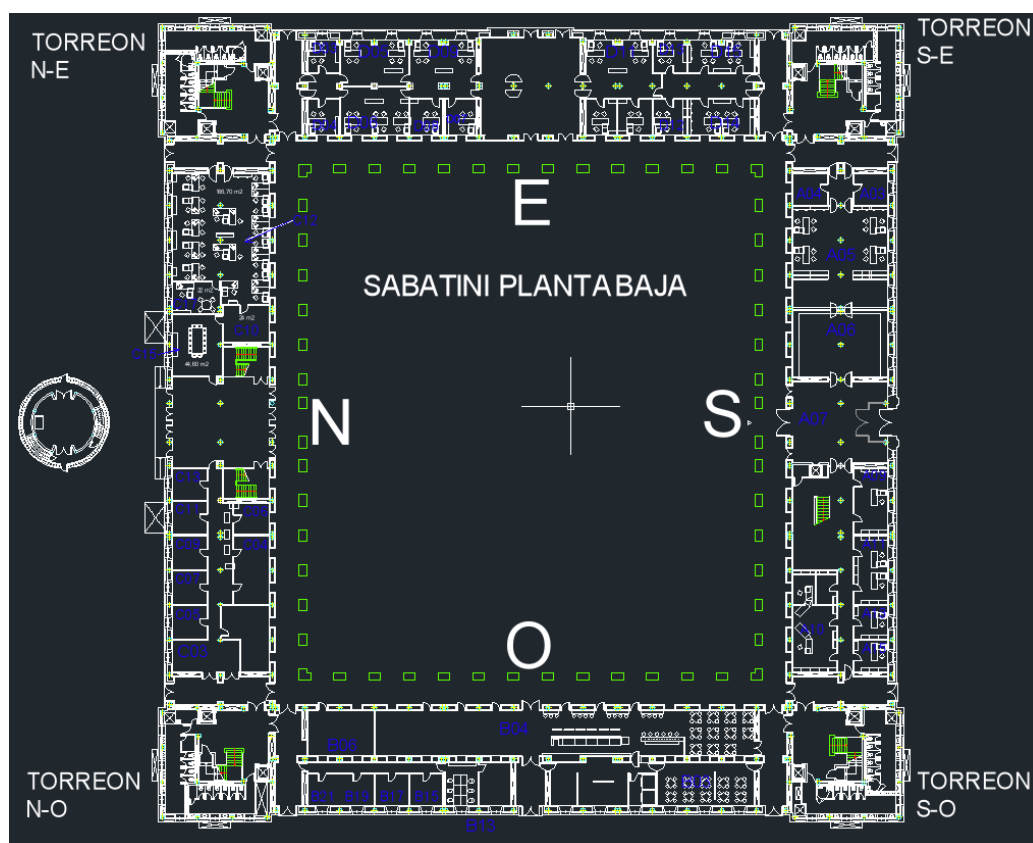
Vista en planta de la planta baja, edificio Sabatini - AutoCAD
